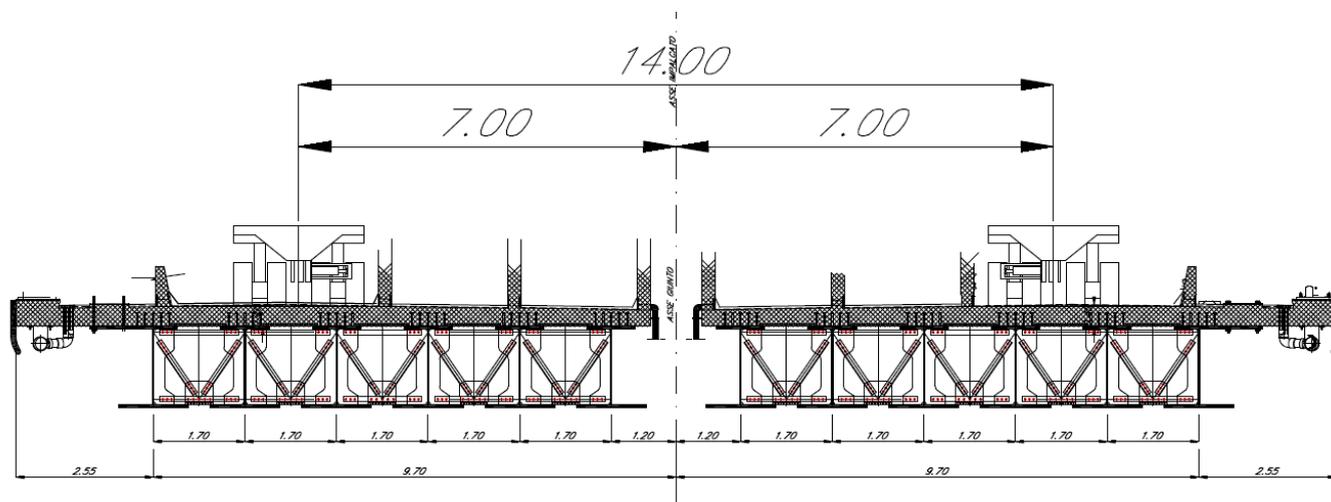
Viadotto Itala Scaletta: sezione trasversale e prospetto binario pari
